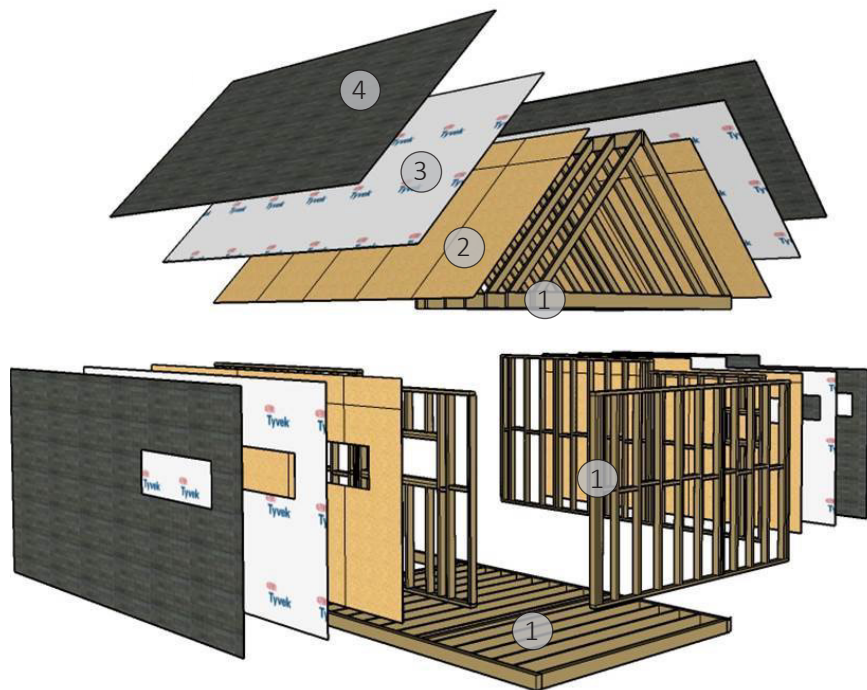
Despiece de estructura. Fuente: A+R ARQUITETURA, 2020
